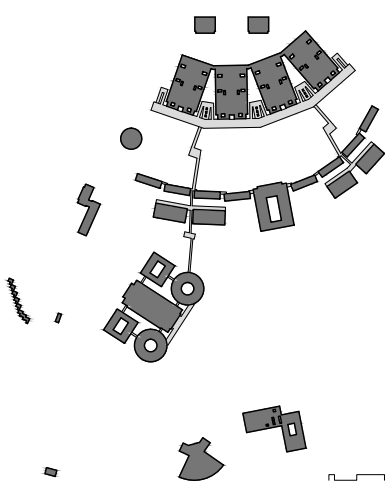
Esquema de la planta general del Centro de Cheste indicando las partes construidas y los vacíos.
